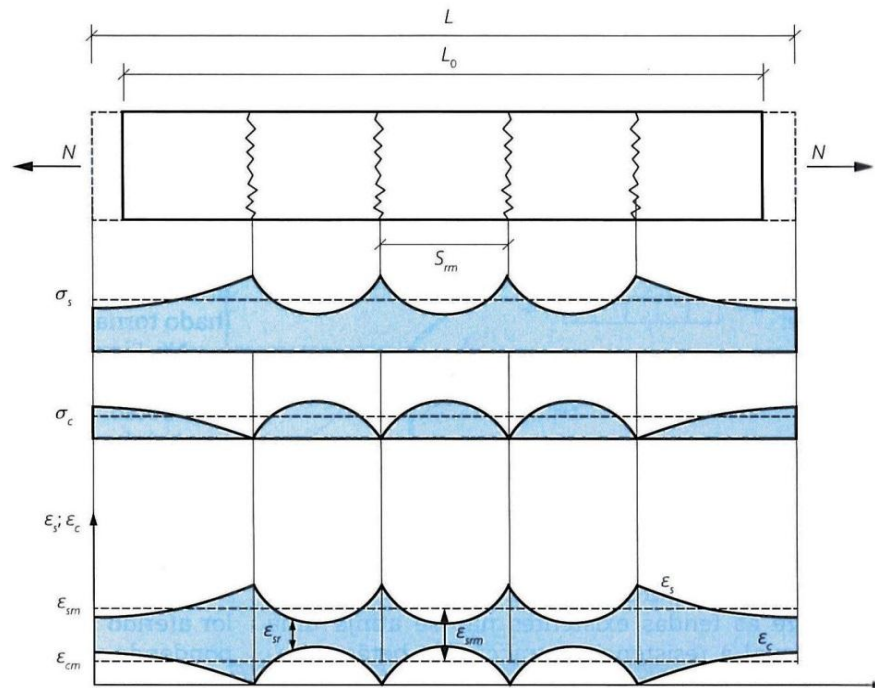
Distribuição de tensões e extensões da armadura e do betão num elemento fendilhado estabilizado [4]
